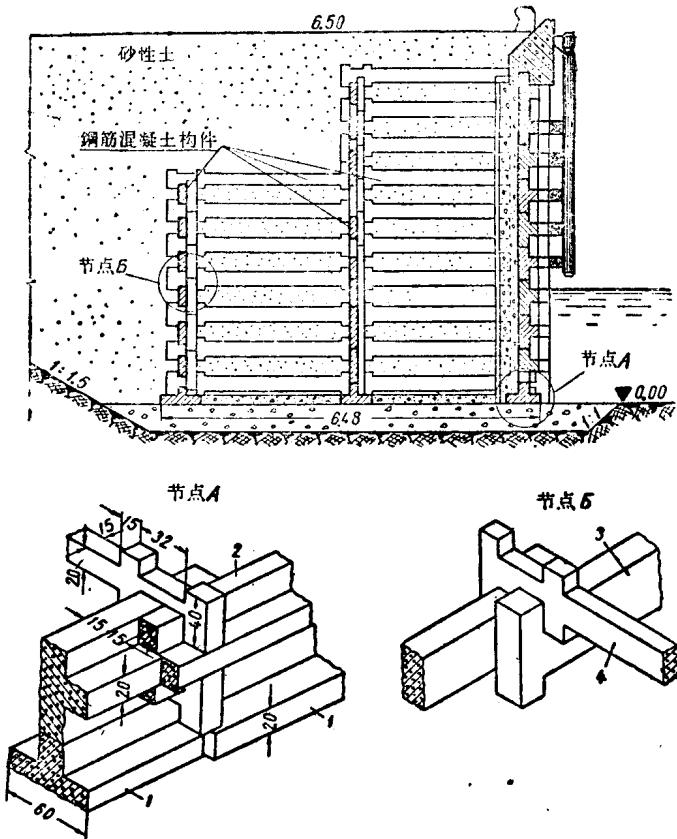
由装配式钢筋混凝土构件组成的框架式岸壁
